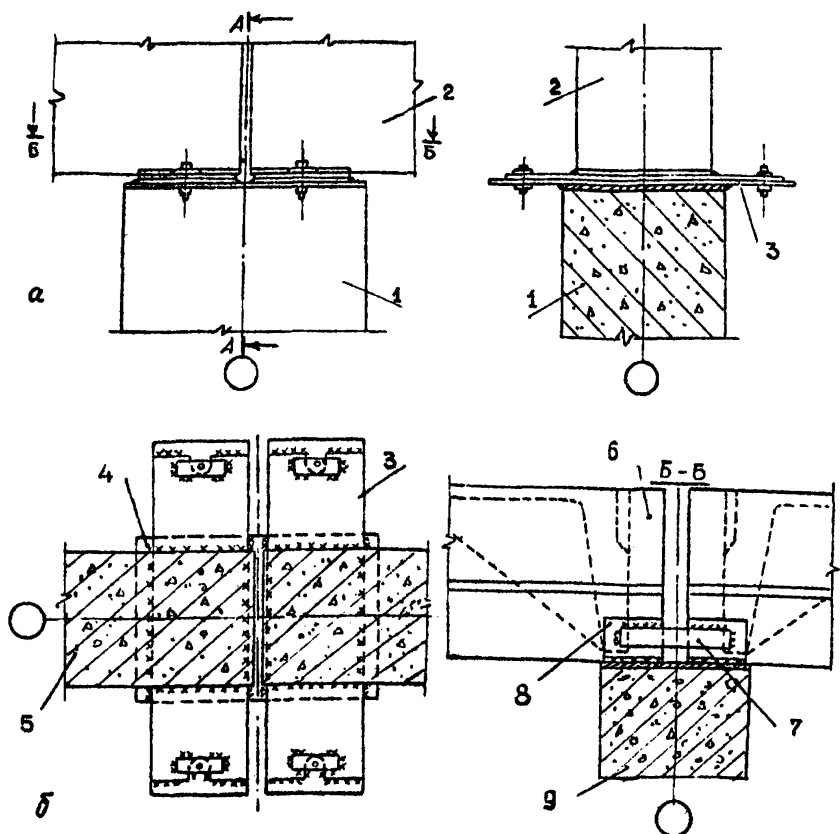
Соединение стропильных ферм с колоннами (а) и опорных закладных деталей продольных ребер плит покрытия, примыкающих к фонарю, в зданиях с расчетной сейсмичностью 8-9 баллов (б):
